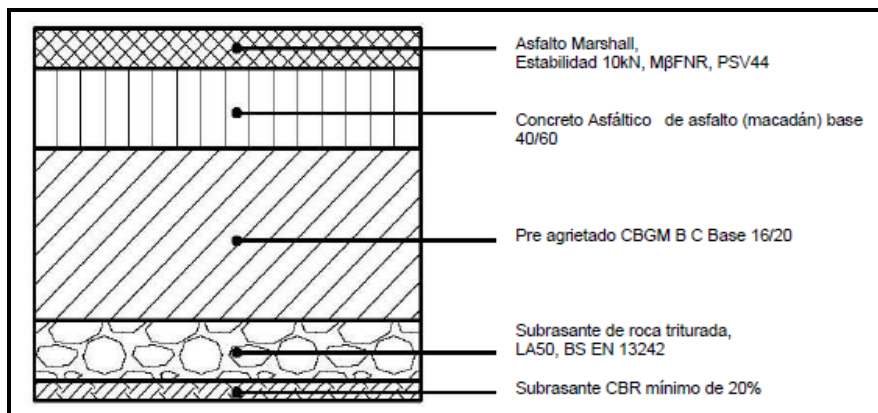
Construcción de calles de rodaje de Código E y F (típico).
